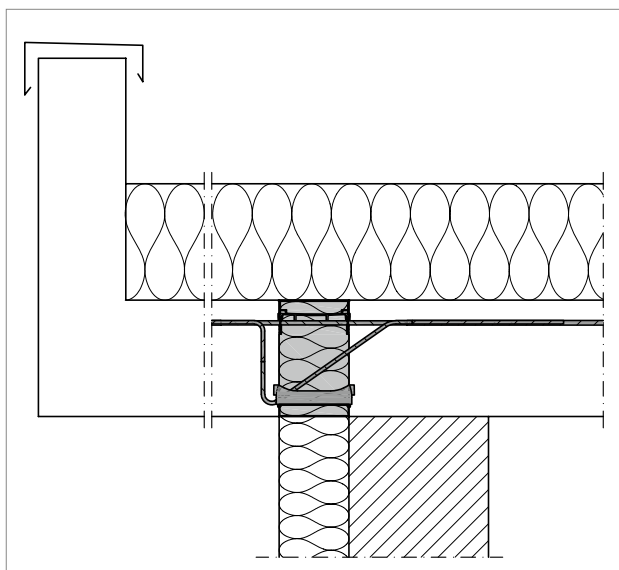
Schöck Isokorf® XT type K: Aansluiting bij enkelwandig metselwerk
